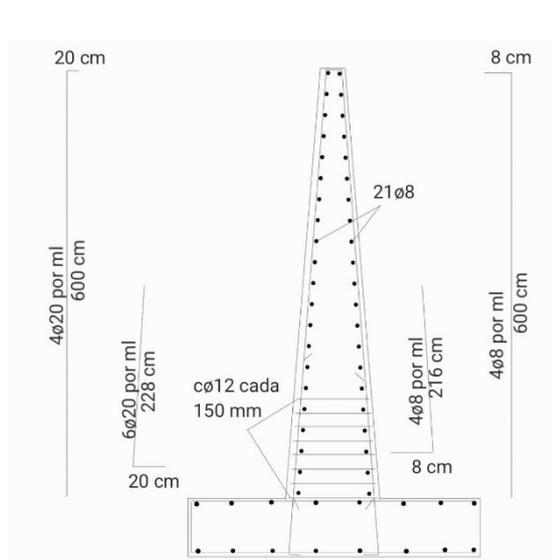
Disposición del armado para un muro de seis metros y canto variable (Fuente propia)
